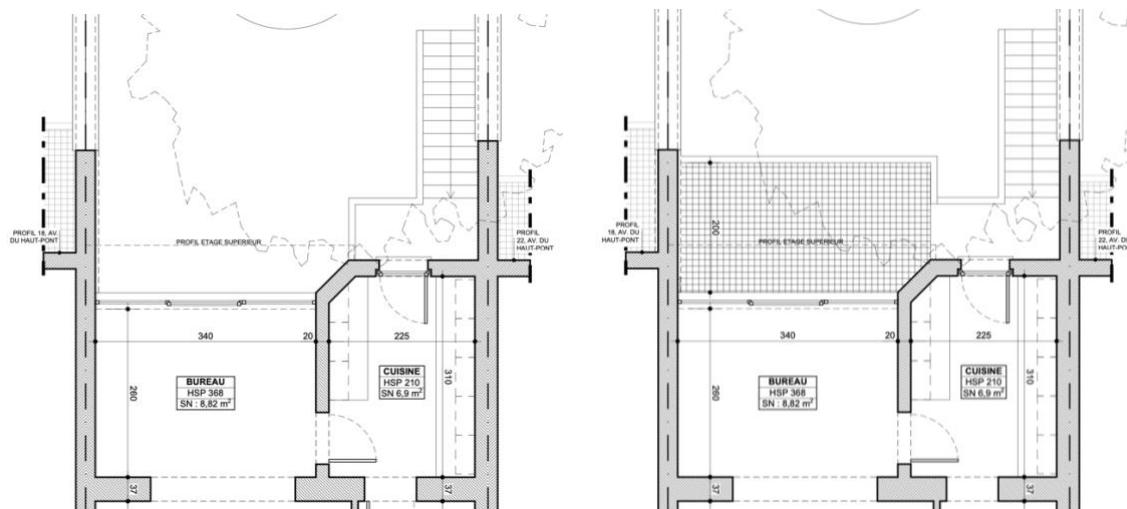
Installation d'un balcon en façade arrière, en caillebotis métallique. Situation de droit à gauche, de fait à droite. On note que la profondeur du balcon ne dépasse ni celui du voisin de gauche, ni celui du voisin de droite, tous deux installés antérieurement.
